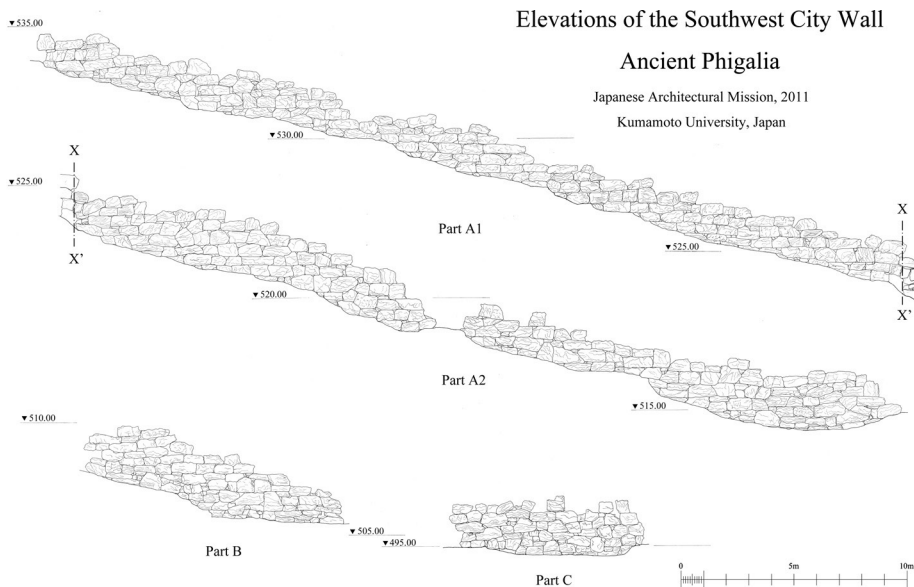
フィガリアの南西部の囲壁のエレヴェーション (熊本大学メッセネ・フィガリア調査隊)
